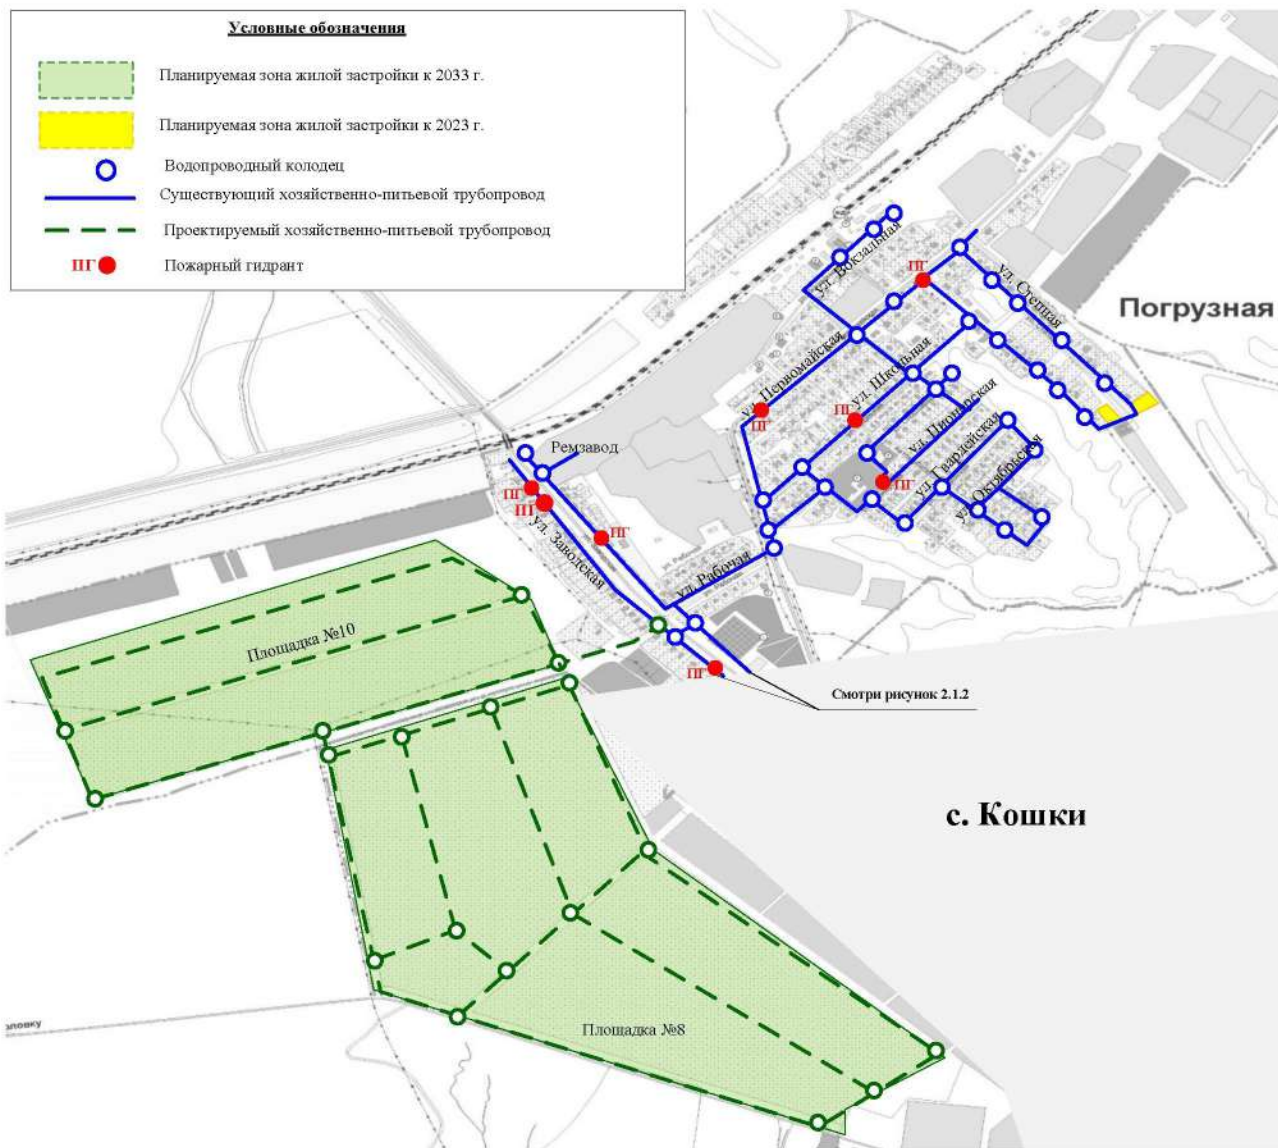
План водопроводных сетей на момент развития
